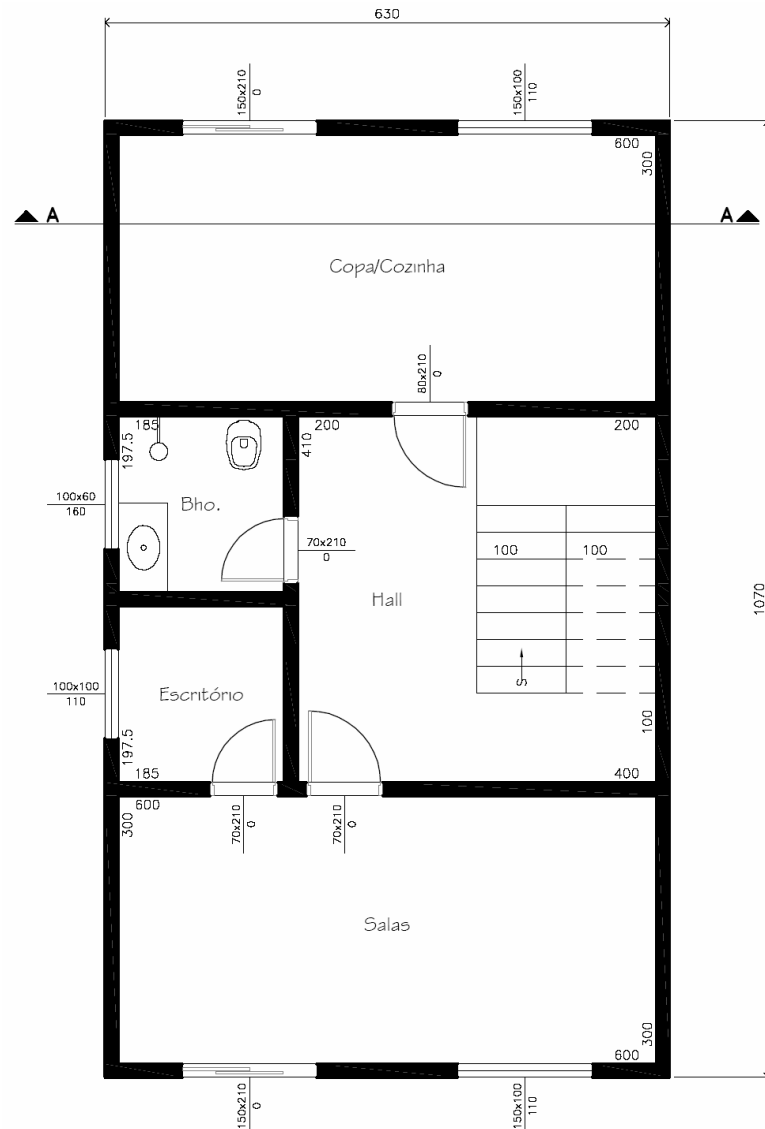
Arquitetura do Exemplo K: pavimento inferior
